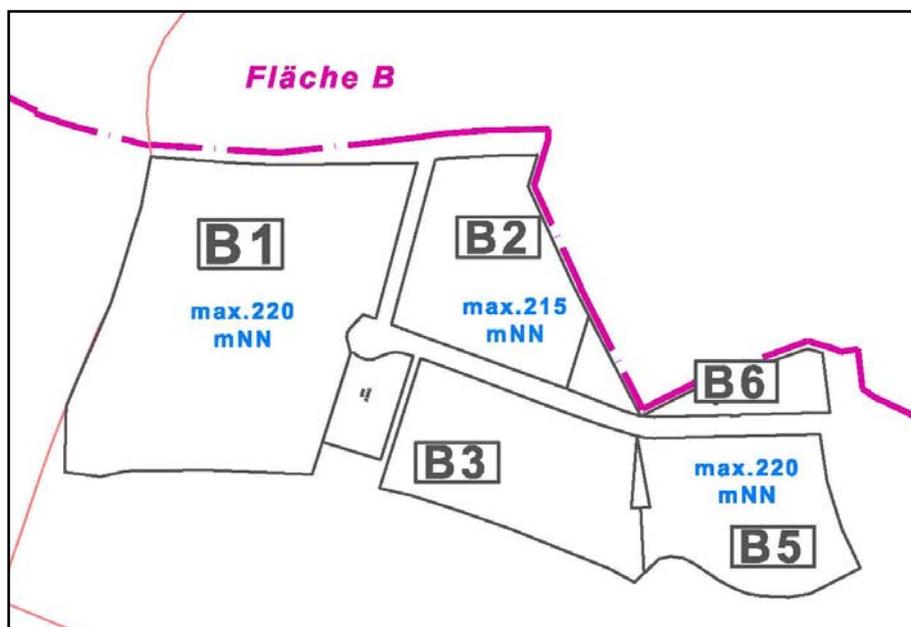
Höhenbeschränkung Fläche B (vgl. Plan 9 im Anhang)
